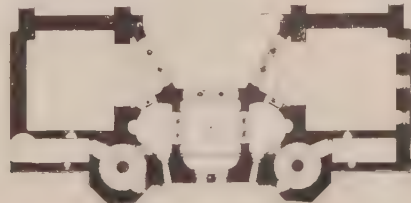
Section horizontale du 2<sup>d</sup> étage.
